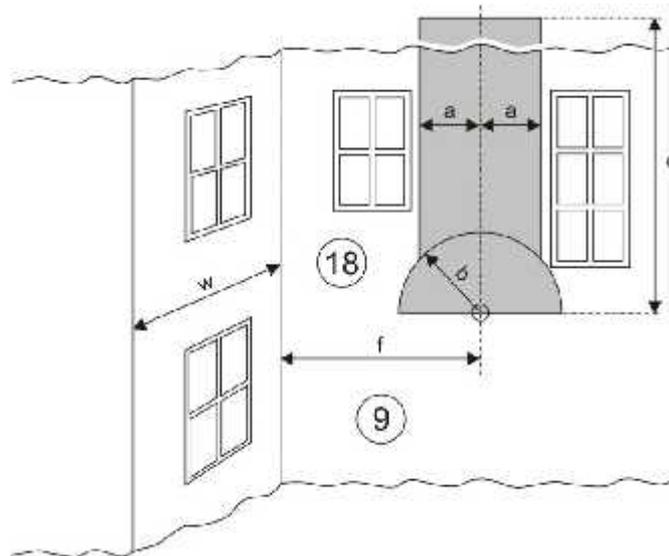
Débouché du terminal en façade à proximité d'un angle - Pan de façade adjacent avec ouvertures
